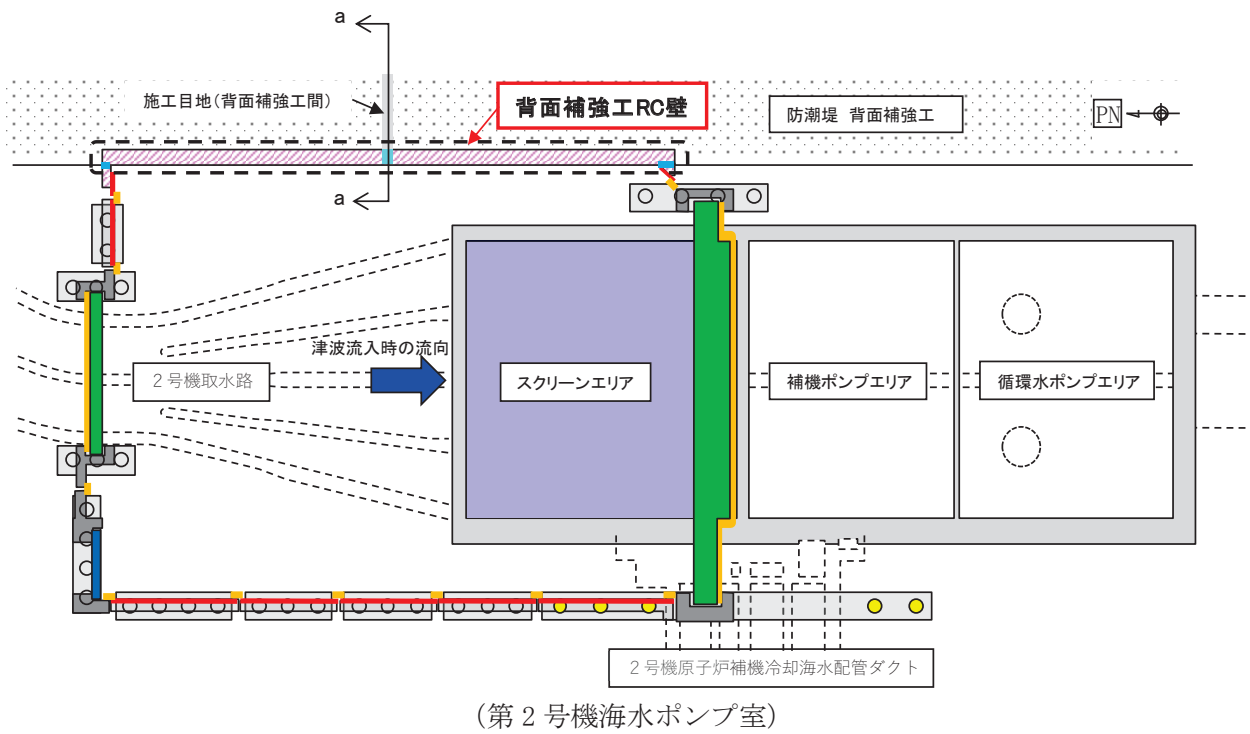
(1) 防潮堤背面補強工部の構造概要図 (平面図)
